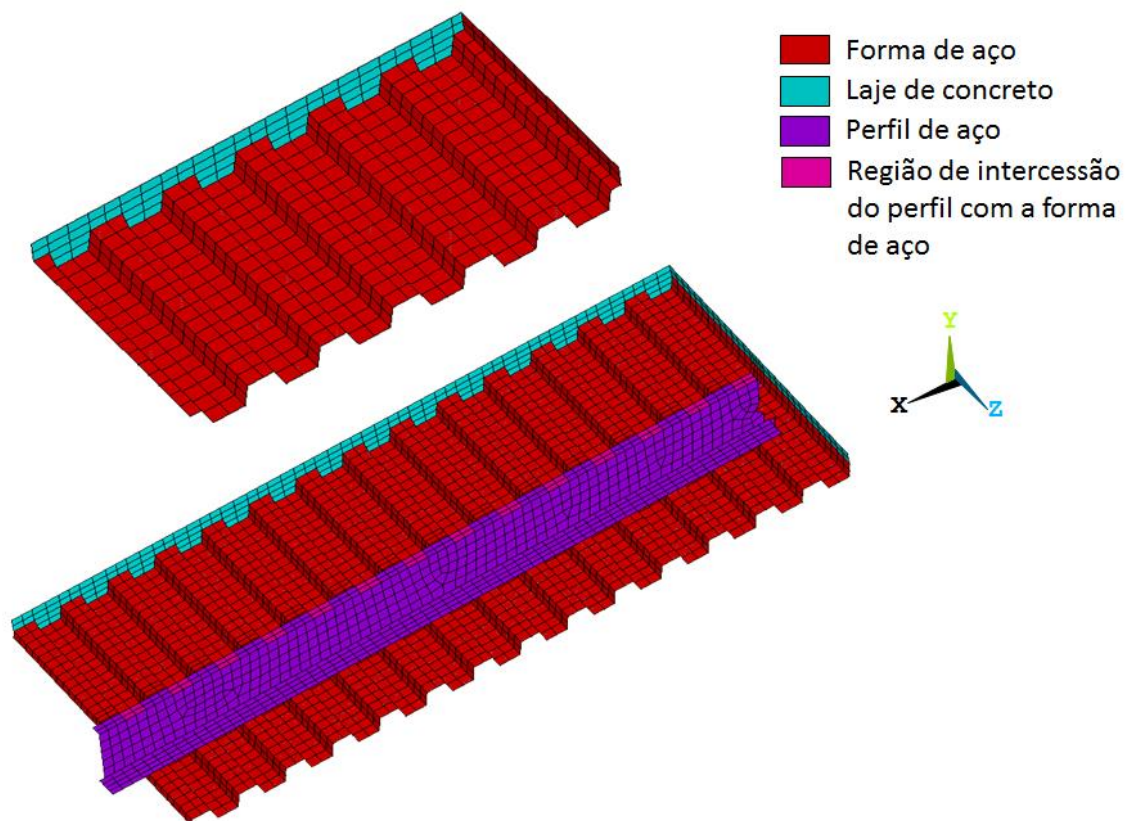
Ligação da fôrma de aço com a laje de concreto e o perfil de aço.
